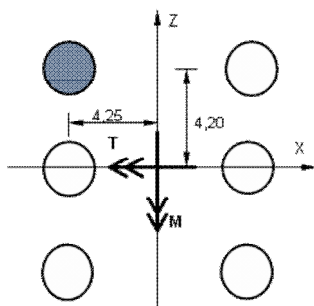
Pianta di riferimento pila tipo con identificazione pila/palo più caricata/o -
